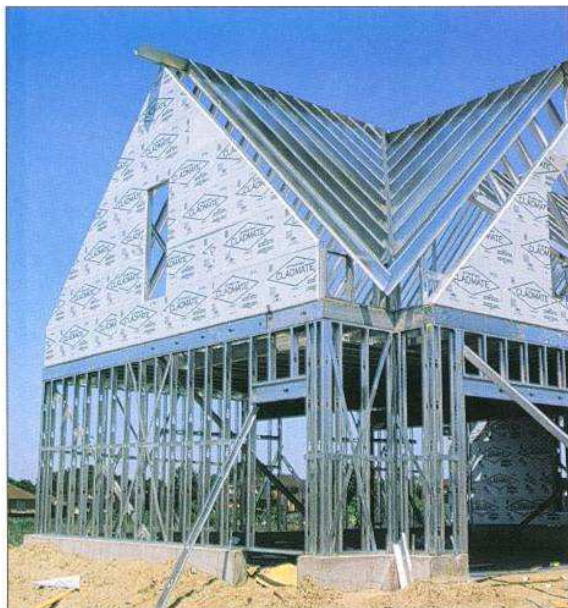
Typowa stalowa lekka konstrukcja kratownicowa- jest to potrzebne dla rozwoju lekkich kratownic stalowych znaczących rozpiętości.(Przykład: zdjęcie po prawej-Lindab profil AB).
